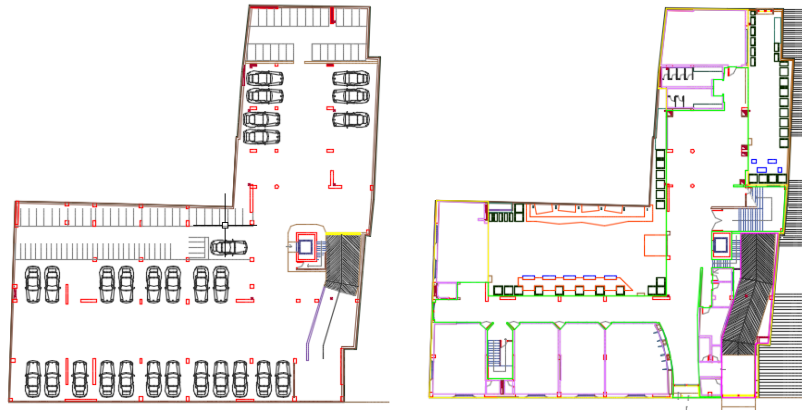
PLANTA SOTANO Y PRIMER PISO
